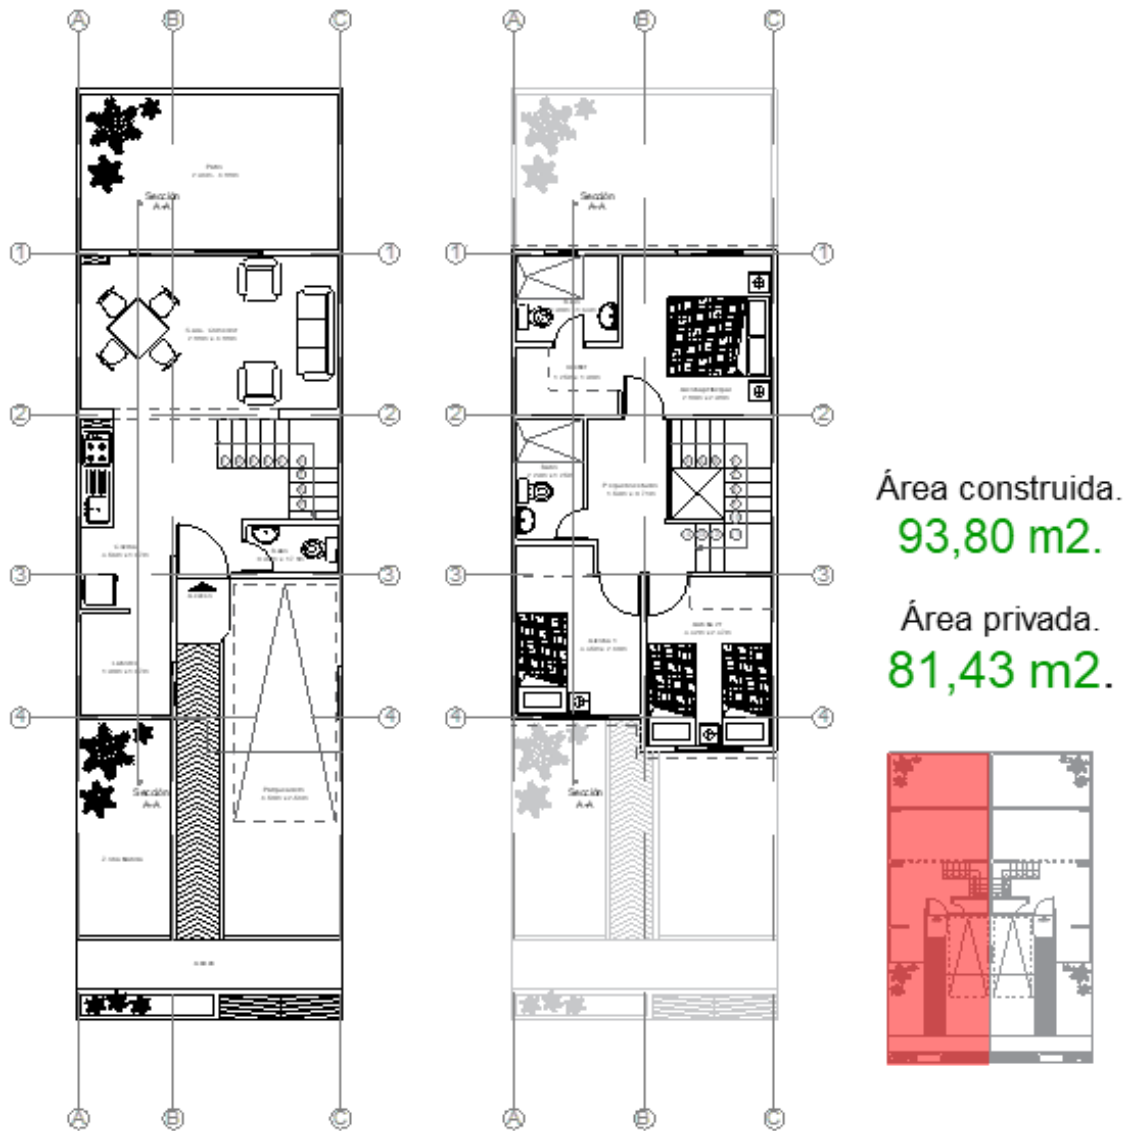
Plantas arquitectónicas de primera y segunda planta. Fuente: elaboración propia.
